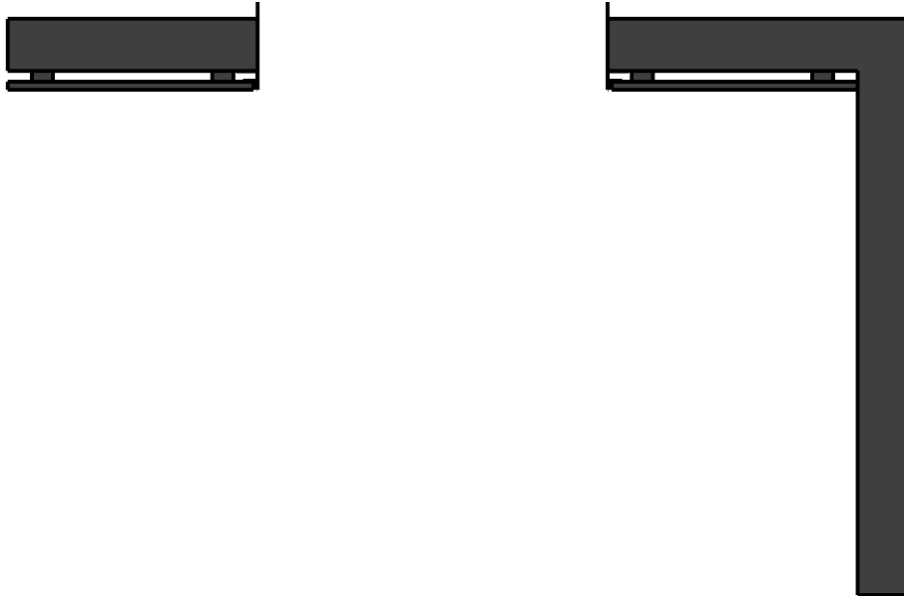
Horizontalschnitt des Prüfstandes mit Fassadenaufbau in 0,5 m Höhe.
